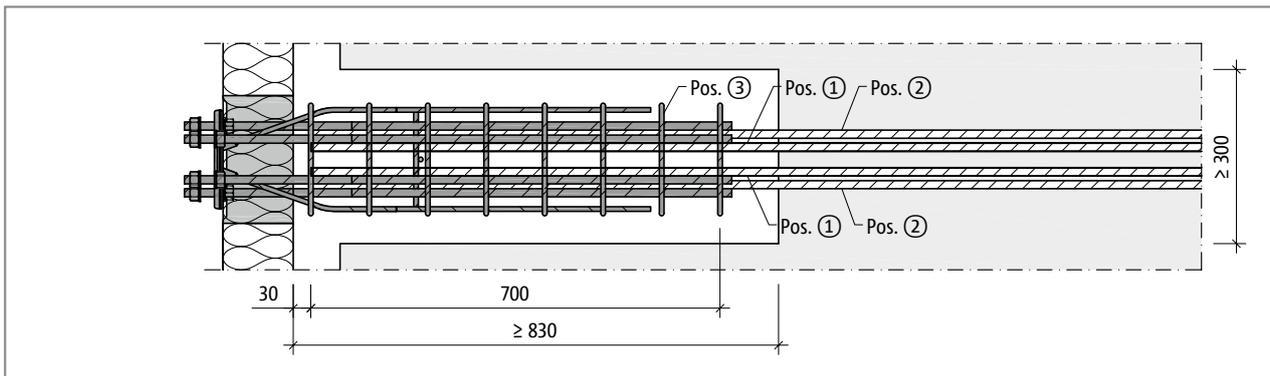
Schöck Isokorb® XT Typ SK-MM1-VV1: Bauseitige Bewehrung bei Halbfertigteilbauweise, Grundriss
